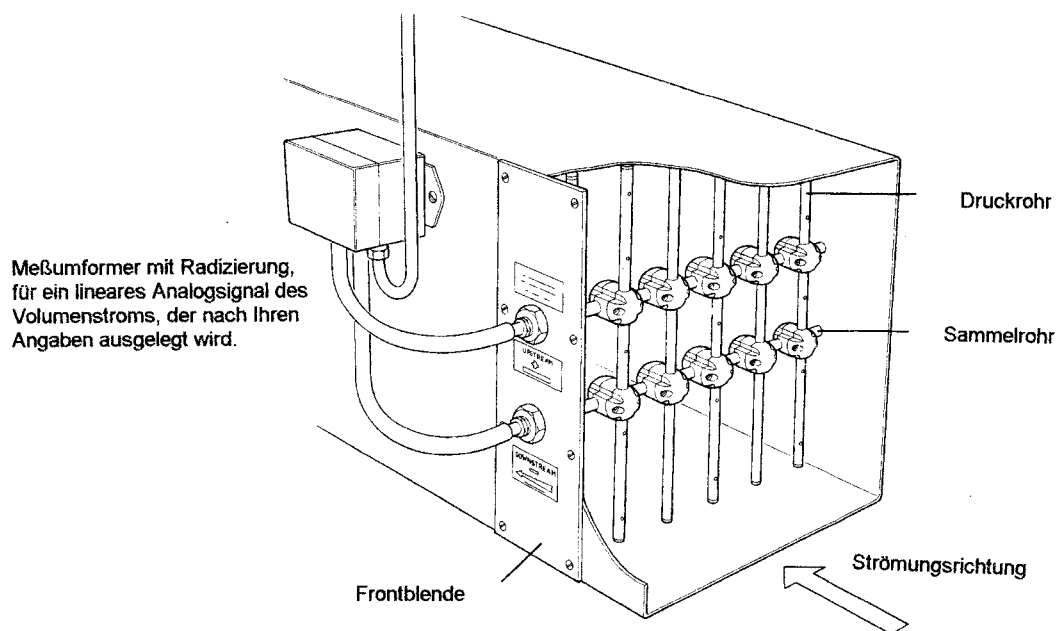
Frontblende und Verbindung zum Druckmeßumformer
